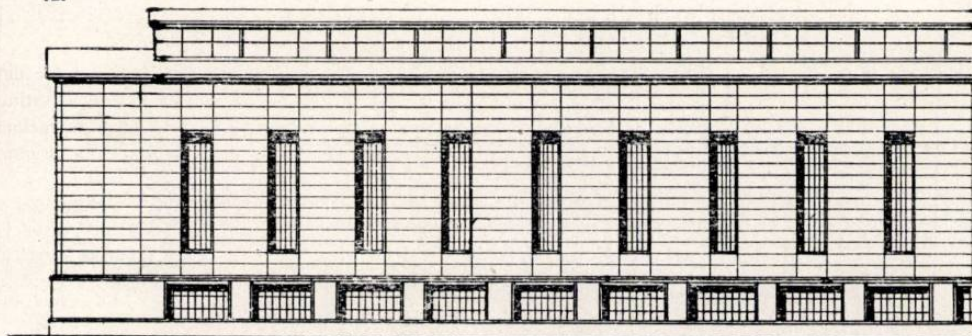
Plăci pentru pereți, ferestre, ancadrame și cornișă prefabricate din beton armat — Schemă de montaj.
